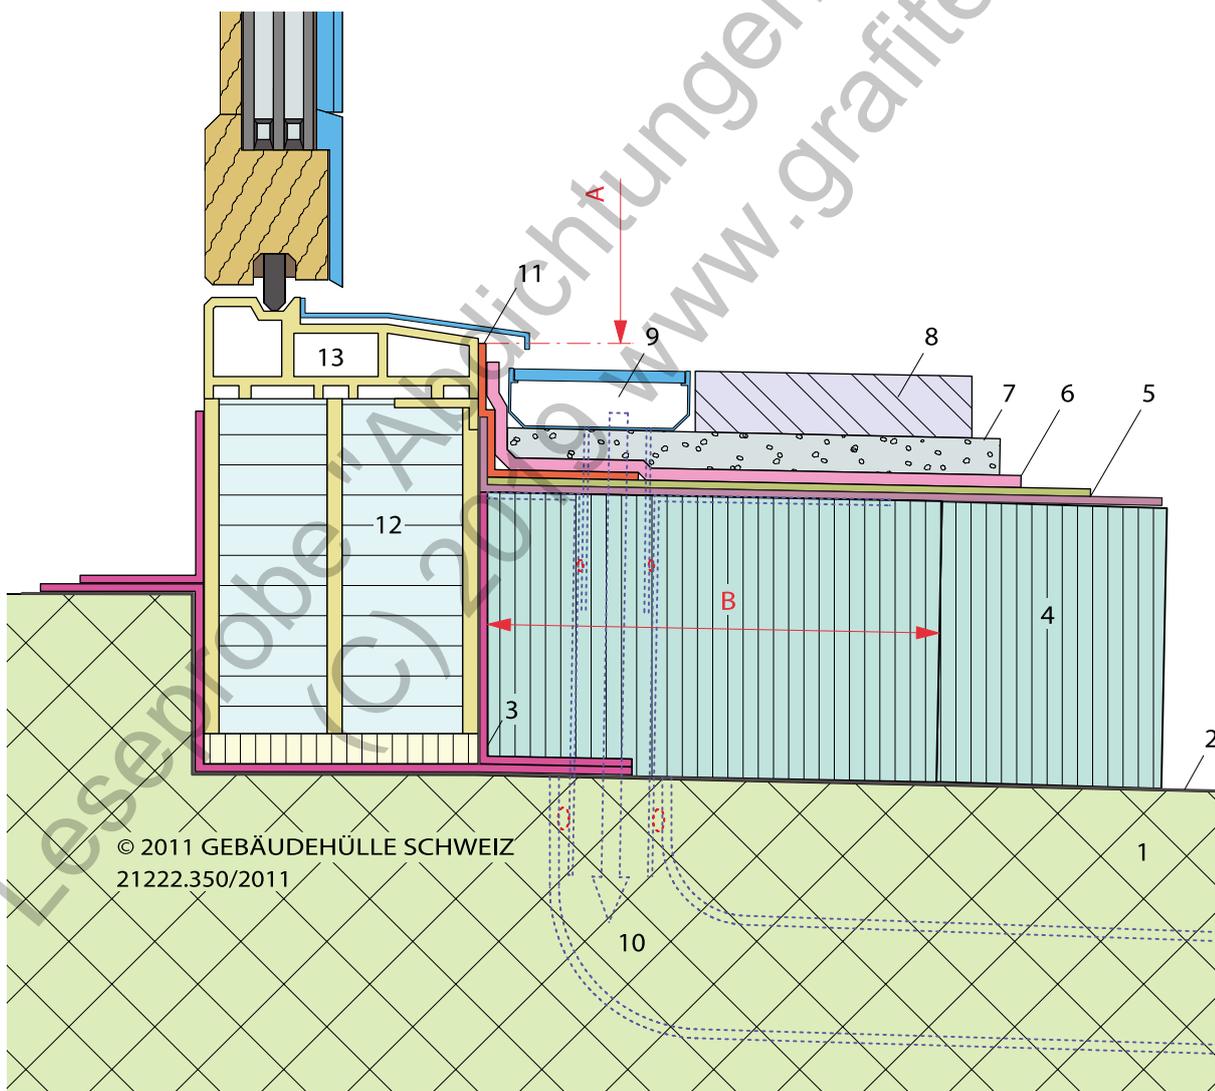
/101: Warmdach; Wandanschluss gedämmt mit XPS und Deckstreifen
